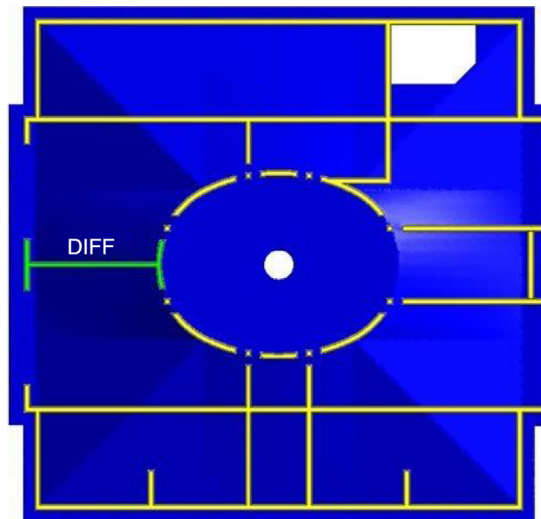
Losa reticular. Localización de los muros de carga. El muro con un asentamiento diferencial se encuentra marcado como DIFF.
